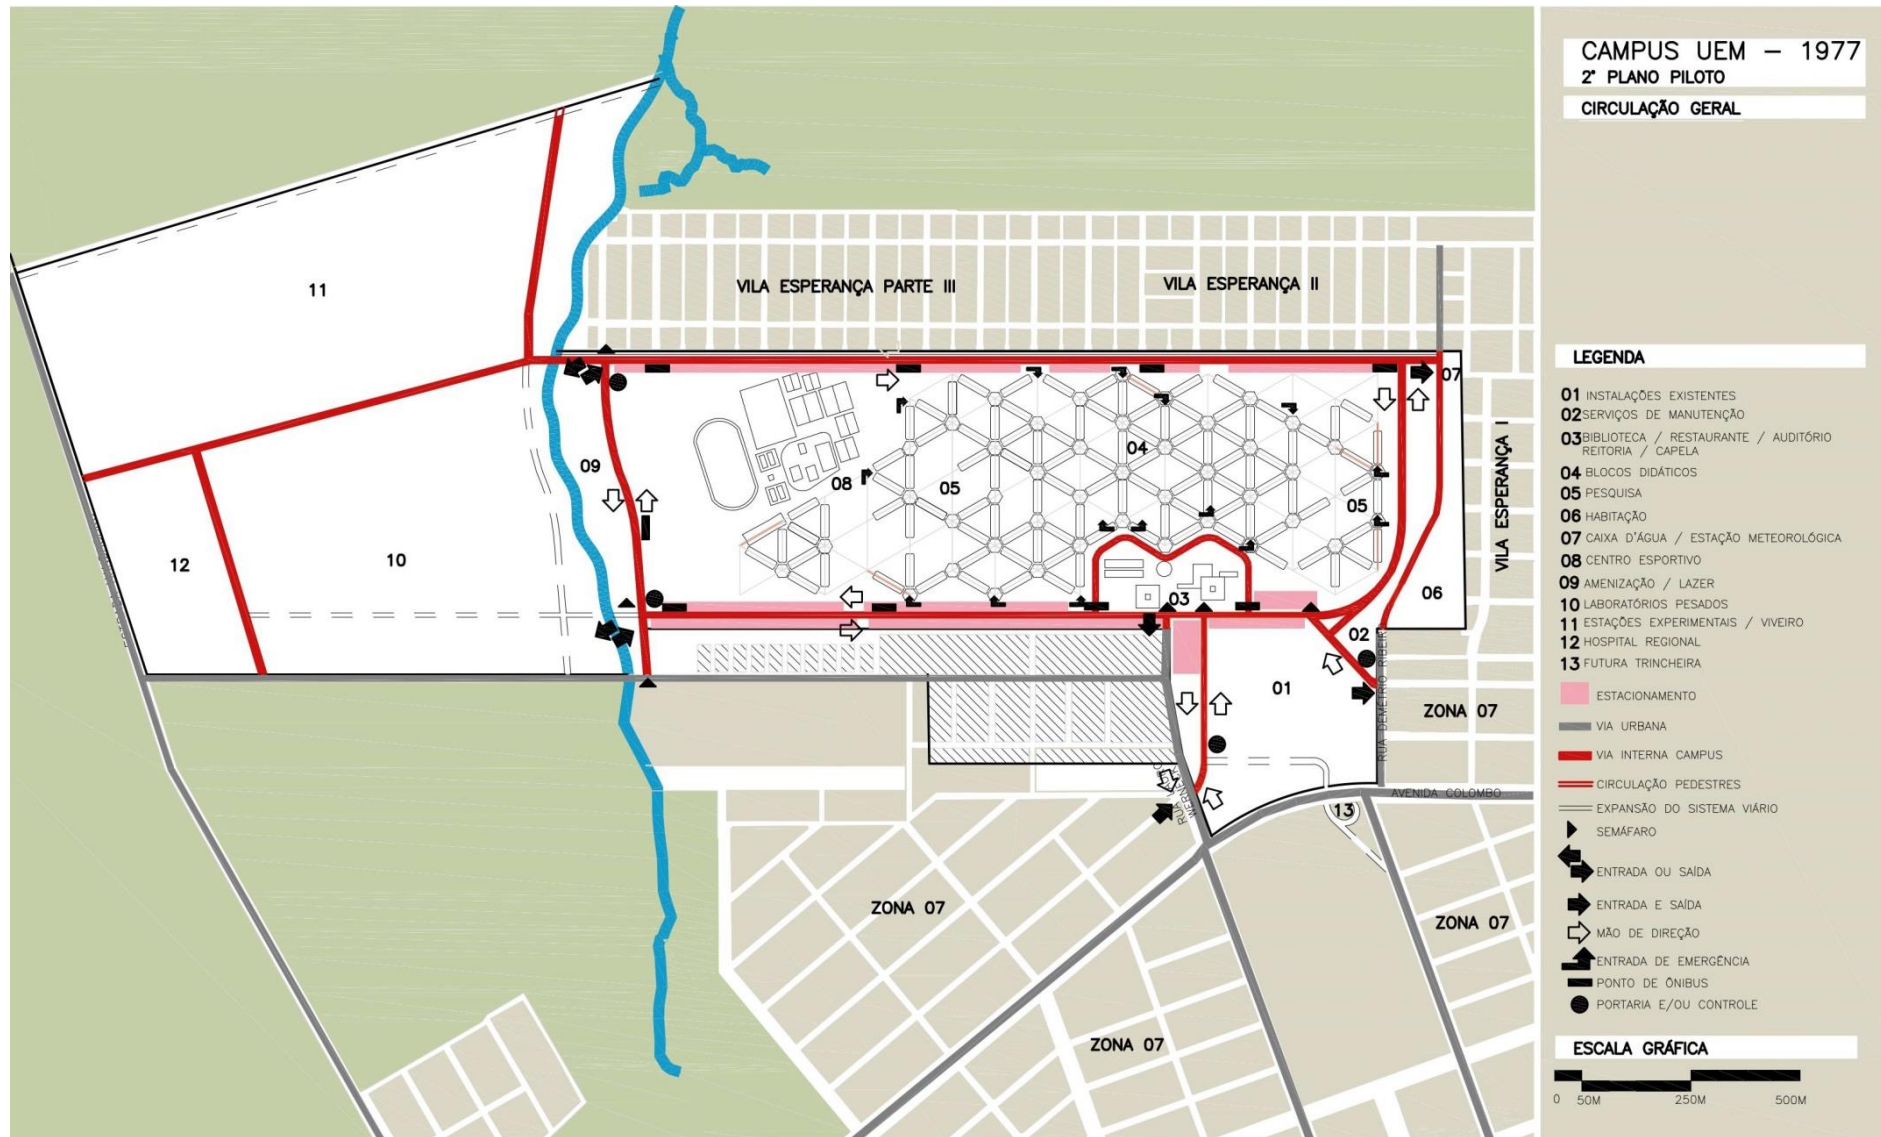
Circulação Geral 2º Plano. Fonte: Mapa Base Prancha 03 – Plano Piloto 1977. Disponível na DOP/PTO. Desenho Renan Avanci.
